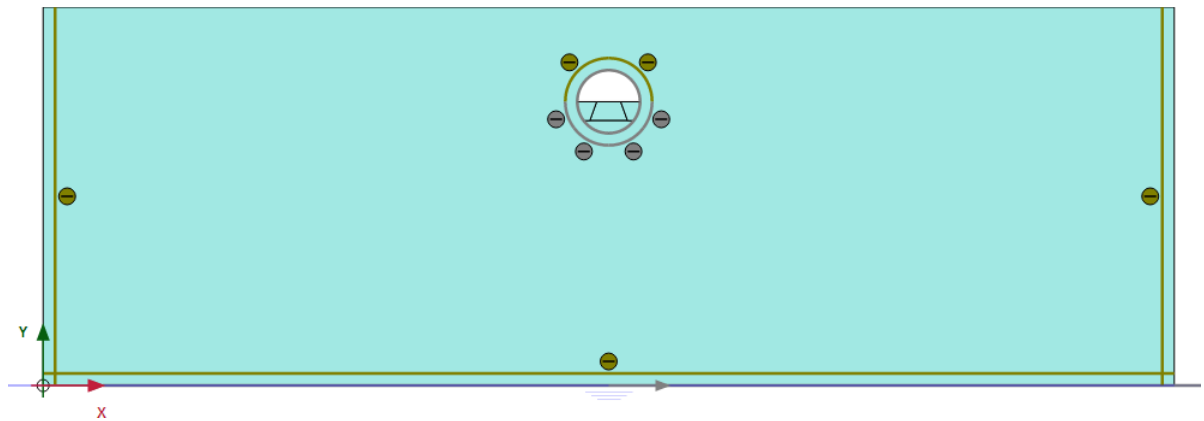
Etapa 1 de construcción, Primera Excavación, Modelo PLAXIS 2D.
